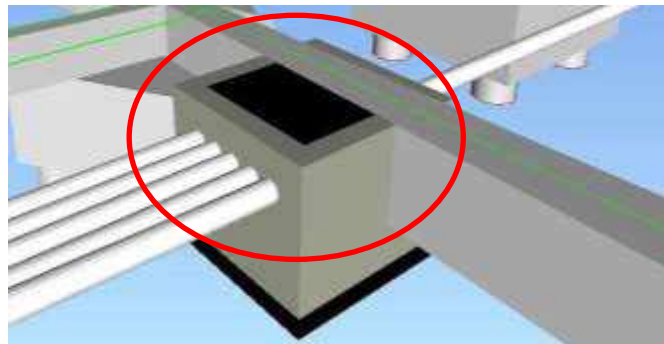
Incompatibilidade Hidrossanitário x Estrutural: tubulação de água pluvial x pilar e bloco
